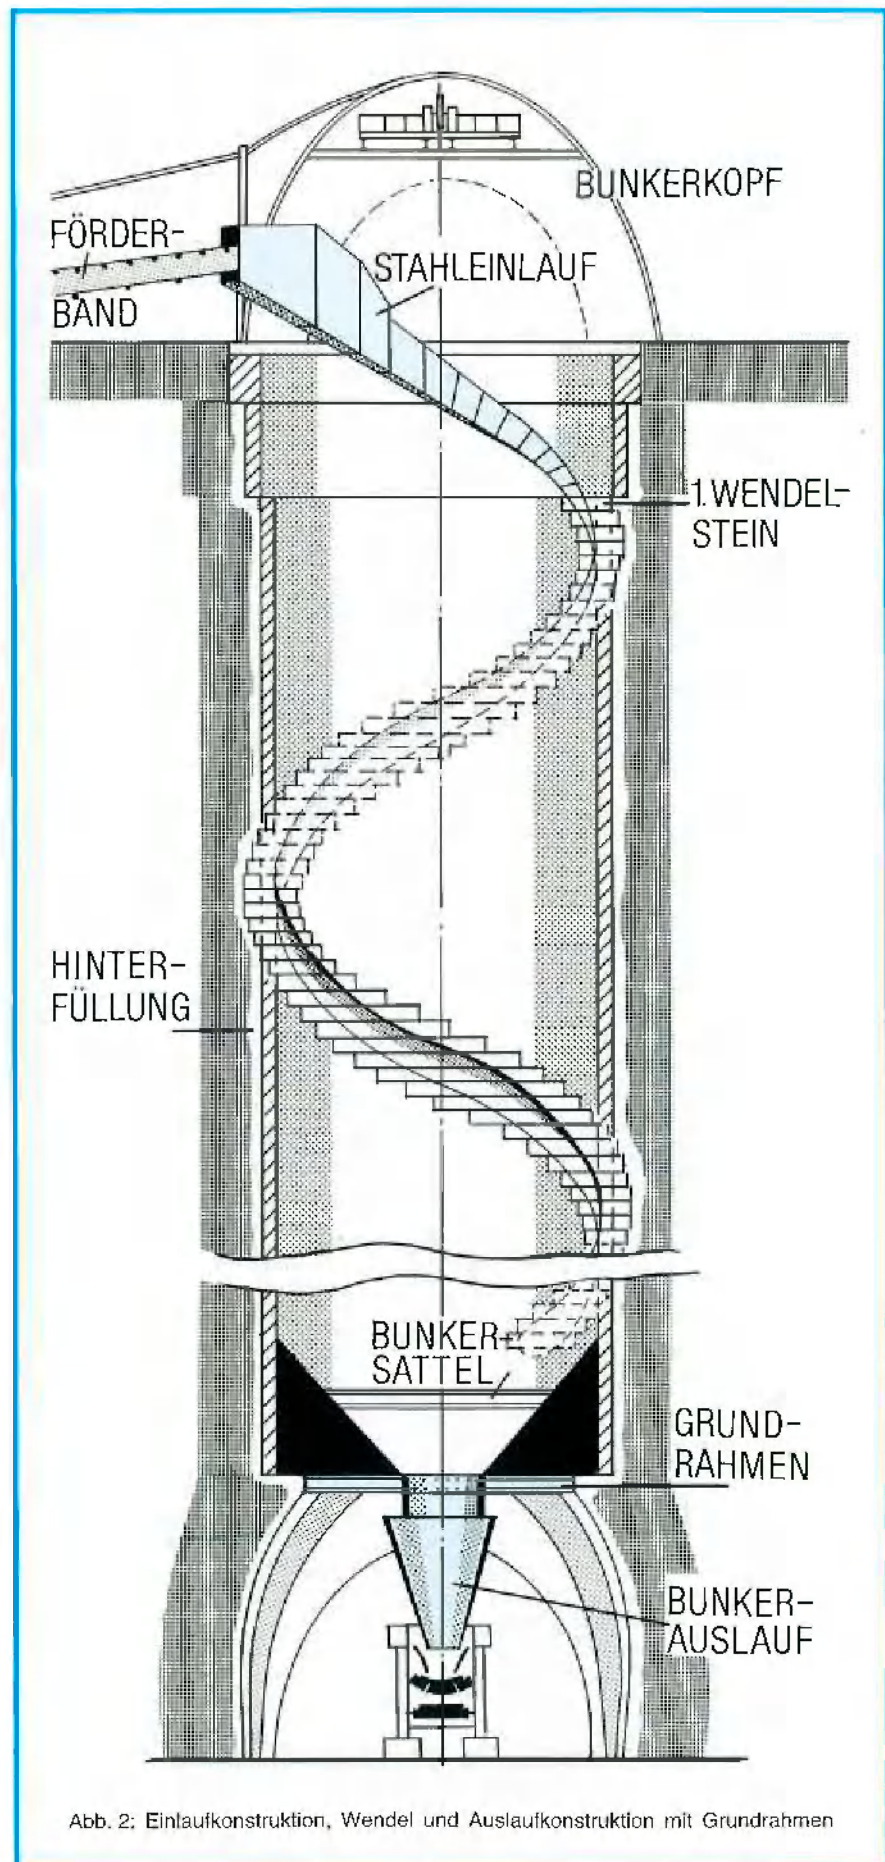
Einlaufkonstruktion, Wendel und Auslaufkonstruktion mit Grundrahmen
